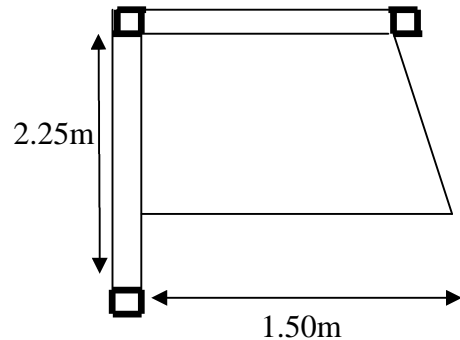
Vue en plan d'une dalle pleine sur 2appuis
